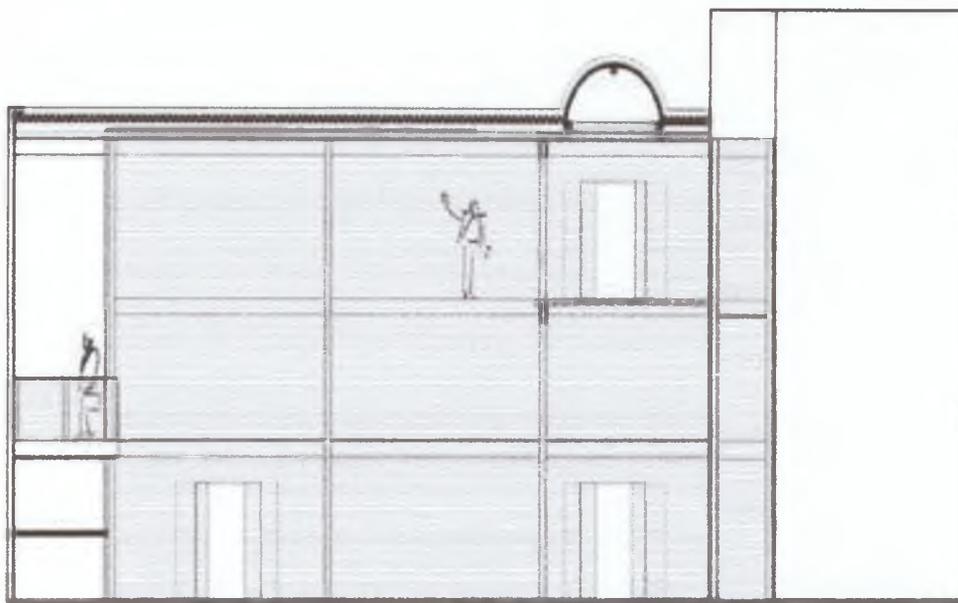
Cortes e elevações do pavilhão anexo à antiga da Casa de Câmara e Cadeia de Florianópolis.
